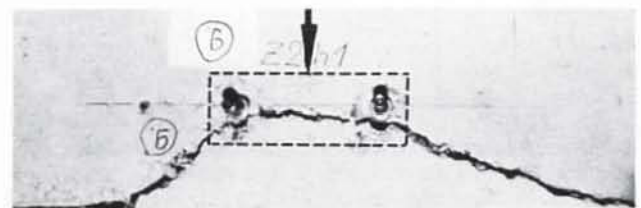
Betonausbruch einer randnah angeordneten Zweifachbefestigung
